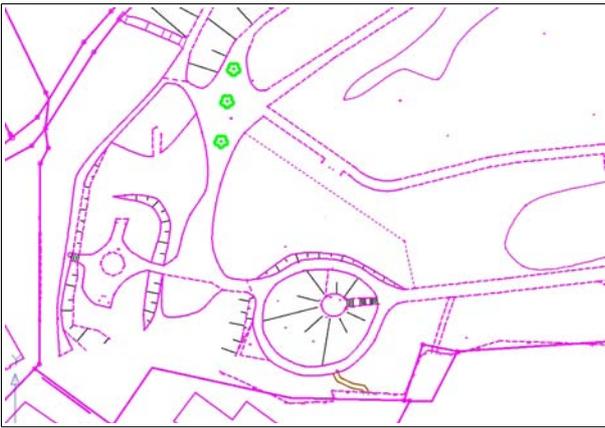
Lageplan 2017, Ausschnitt "Kleiner Garten" / „Neue Anlagen“
